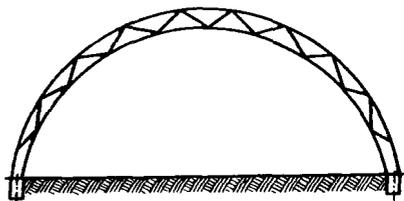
Поперечный разрез пленочной рассадной теплицы.
